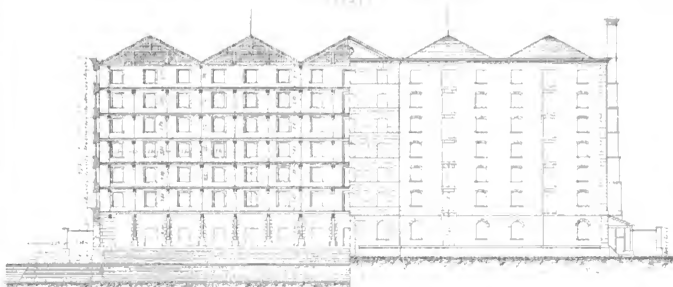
Plan de l'entrepôt de 12 étages (P^r Elevé) de 12 étages
